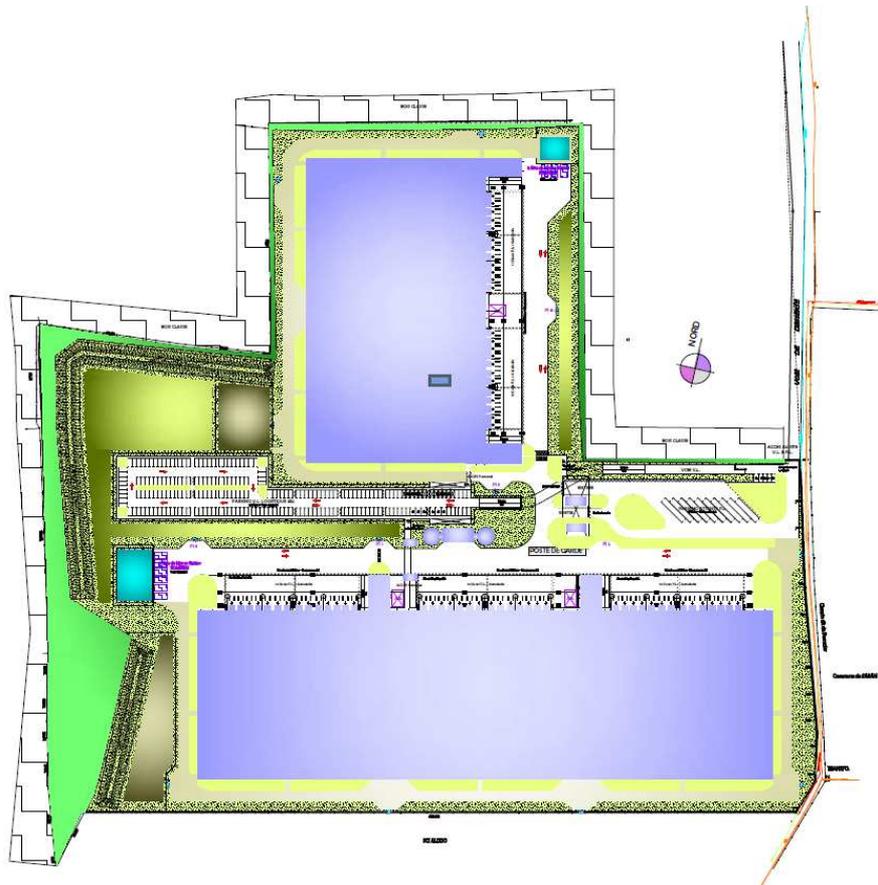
Extrait du plan de masse du projet (Groupe Legendre)
